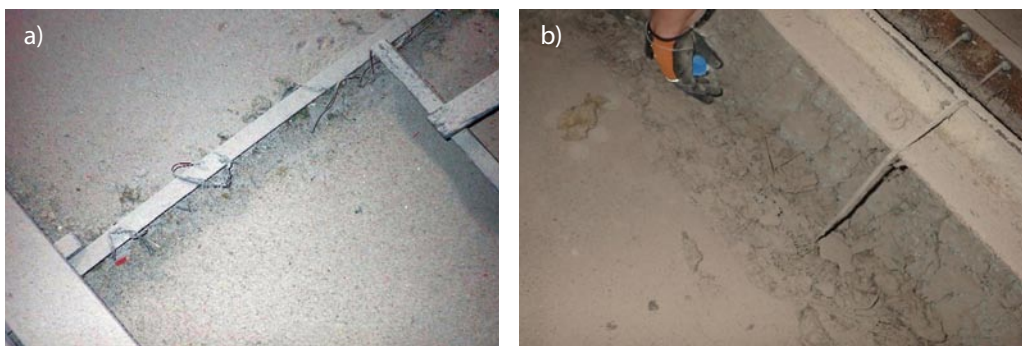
Widok wierzchu żelbetowego sklepienia kolebkowego SK-2: a) w kluczu, b) w poziomie posadowienia
